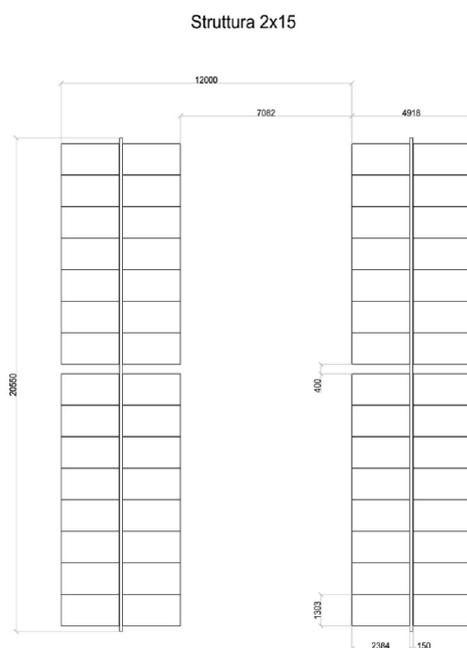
Vista in pianta delle stringhe fotovoltaiche
